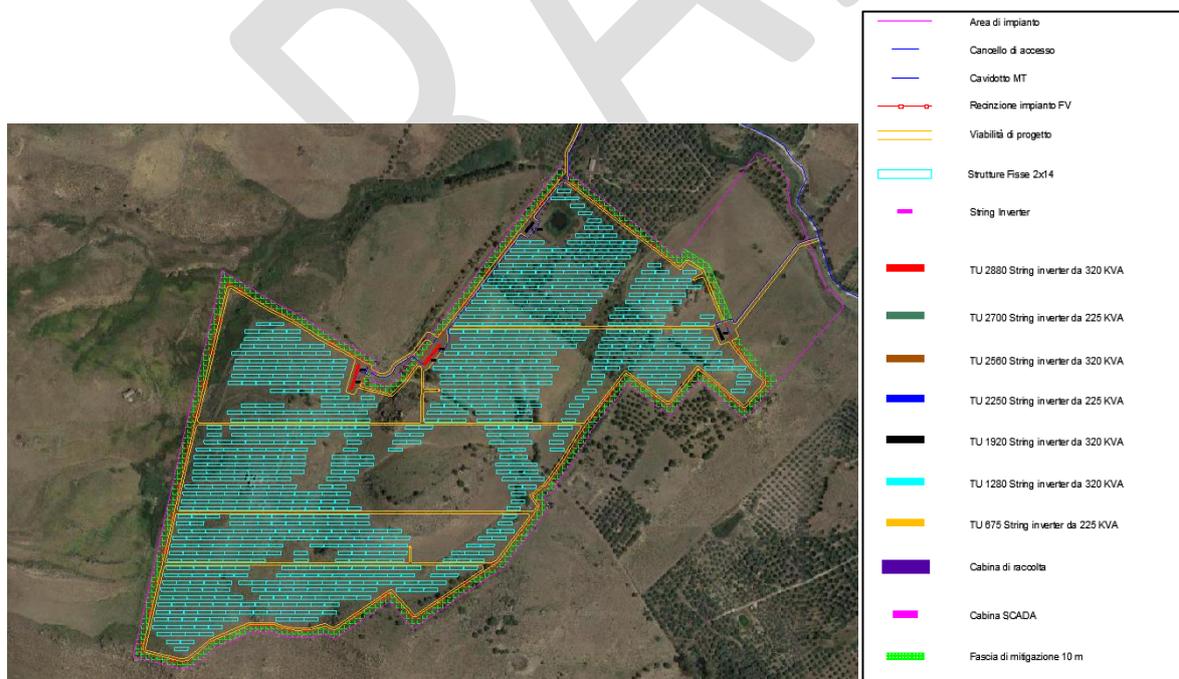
Sovrapposizione su ortofoto del layout di impianto – Lotto 5
